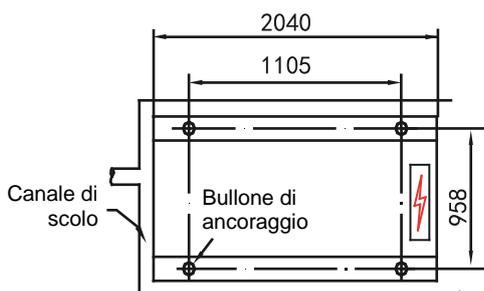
Disegno con dimensioni di installazione SCV-600EA
